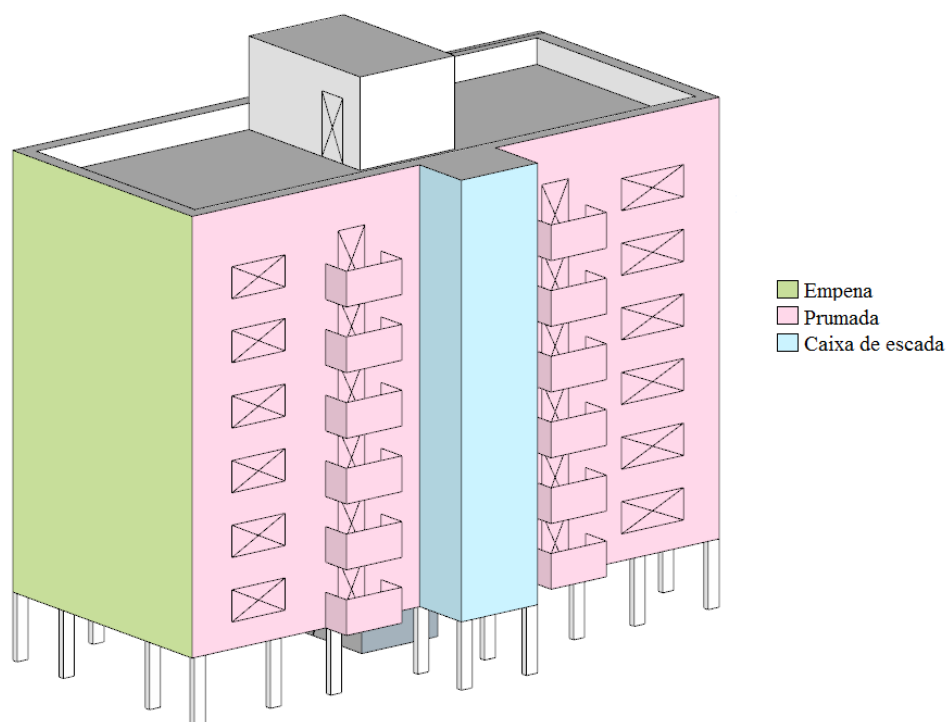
Exemplos dos tipos de elemento construtivo
